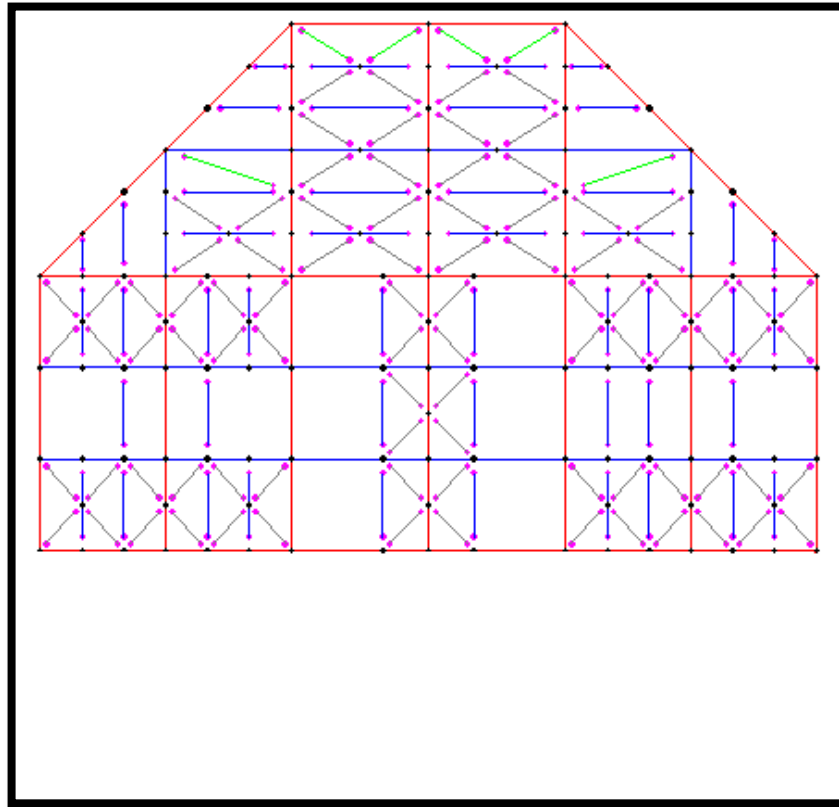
0-100 metre arası kolon kiriş yerleşim planı
